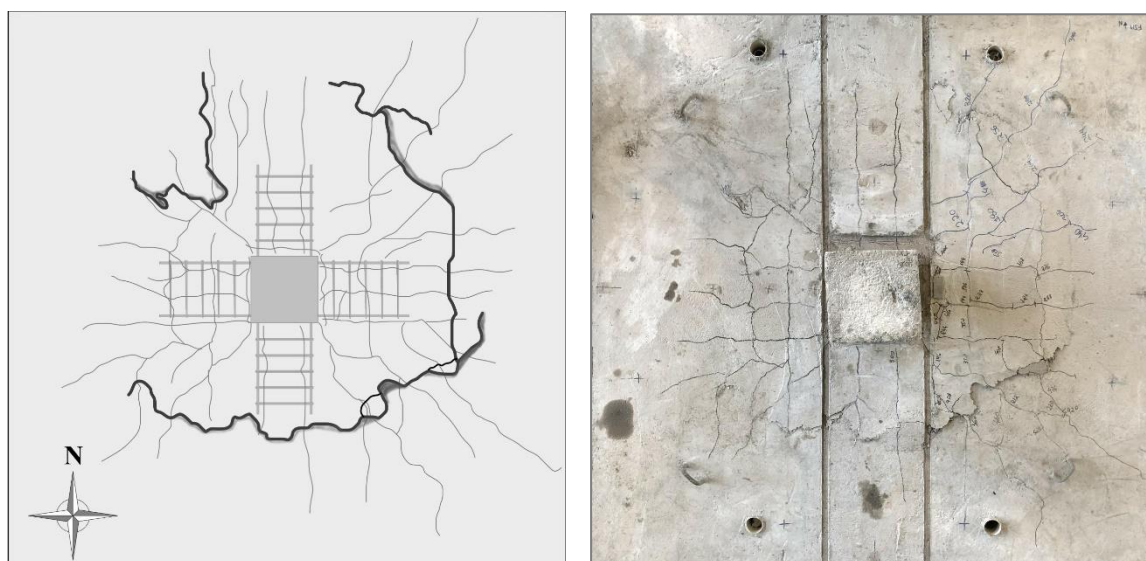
Mapa de fissuração da laje NA-05
